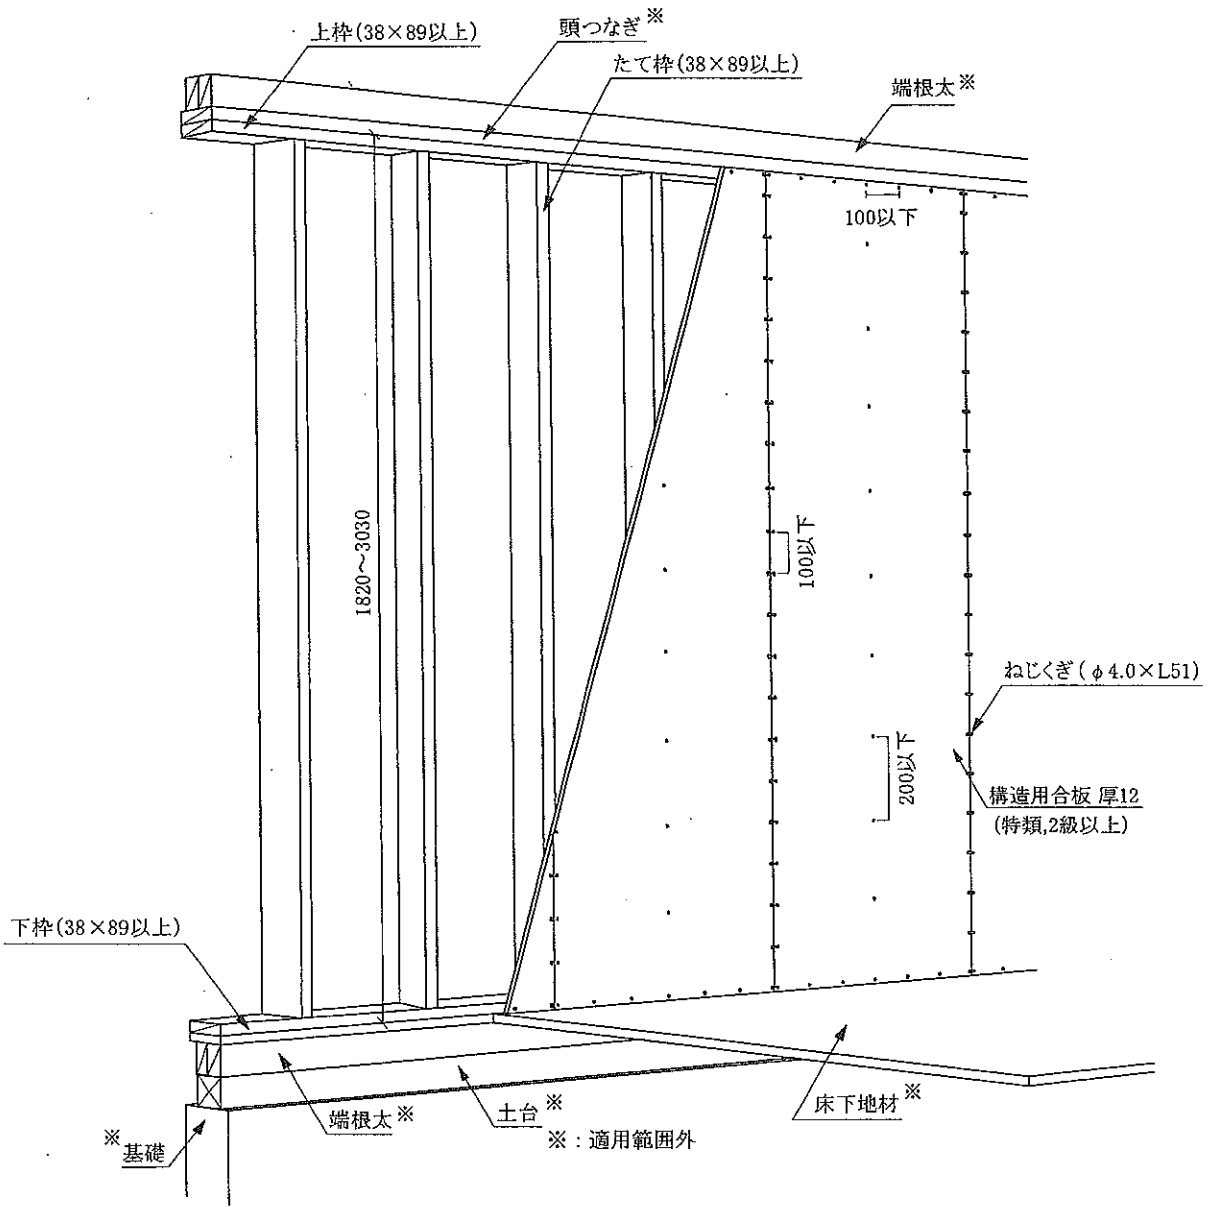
施工図: 1 枚張りの場合 (寸法単位: mm)
